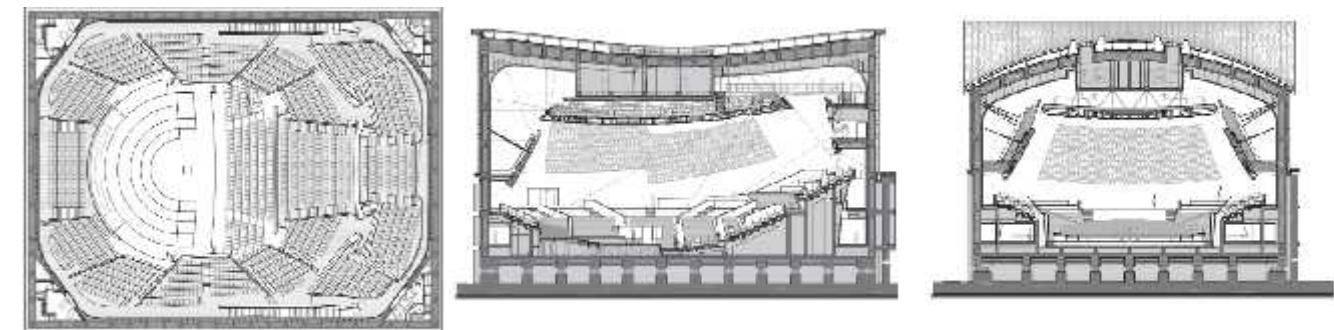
Planos del Shanghai Symphony Hall Fuente: (Toyota, 2016)
